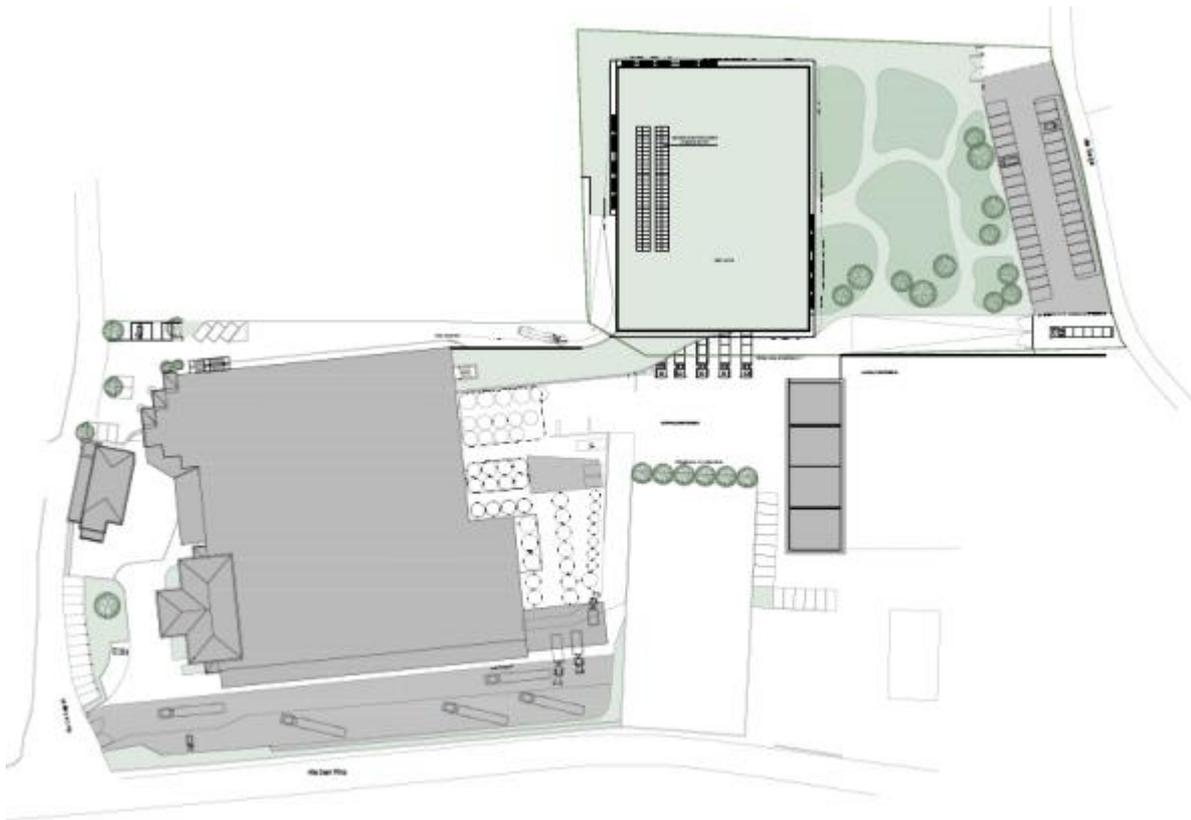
planimetria di progetto con area di massimo involucro volumetrico dell'edificio
